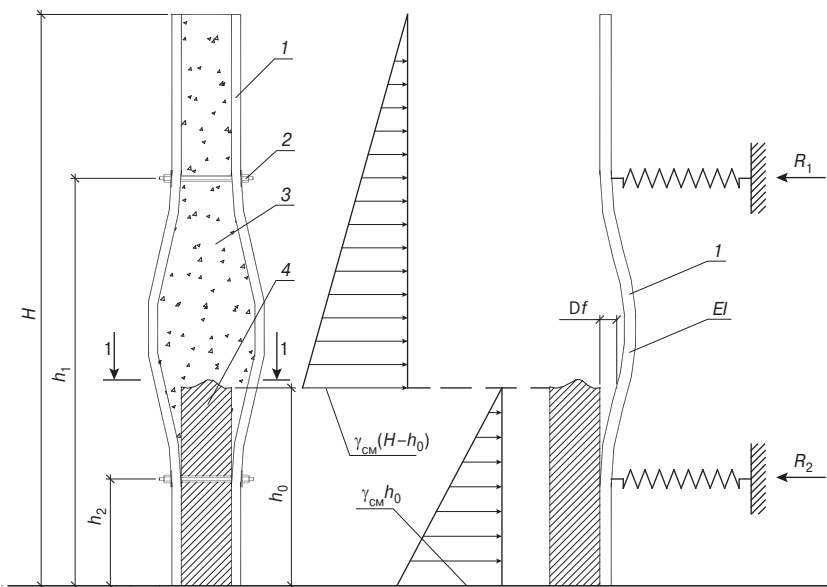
Схема дефектообразования лицевой поверхности бетонной стены: а – схема укладки бетонной смеси; б – эпюры бокового давления; в – расчетная схема щита; 1 – щит опалубки; 2 – тяж; 3 – бетонная смесь; 4 – затвердевший бетон
